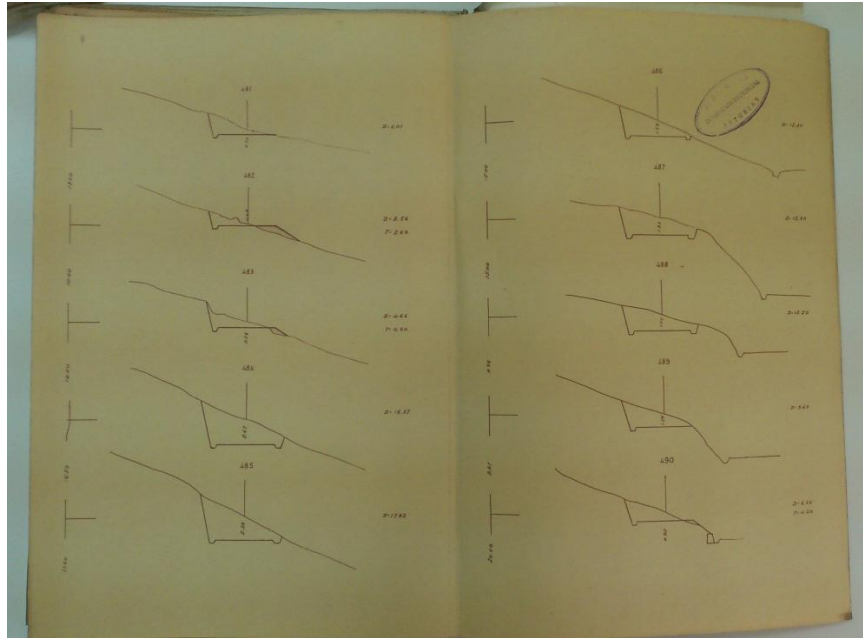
Vista de los perfiles transversales del proyecto del año 1935
